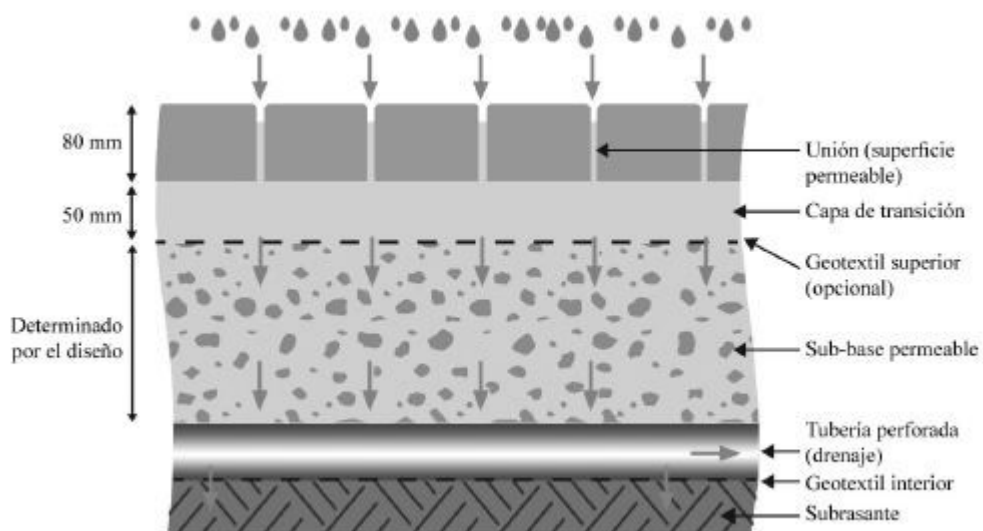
Sección de la estructura de un pavimento permeable con tubería perforada.
